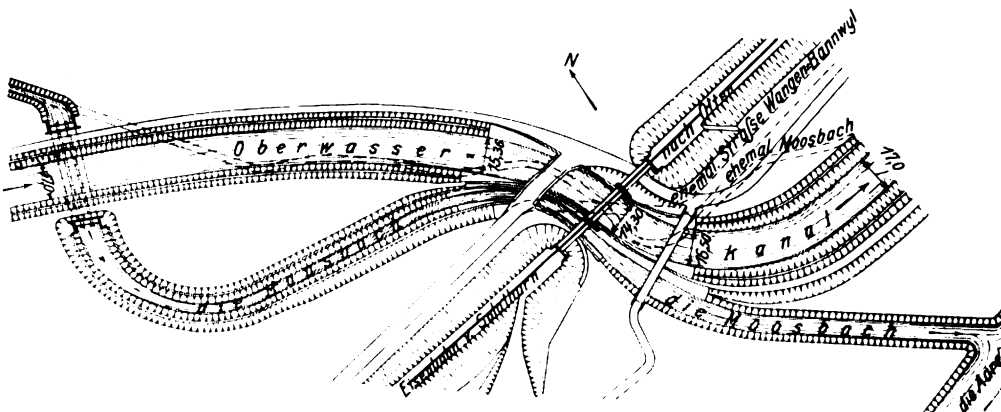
Lageplan des Kanales an der Eisenbahnbrücke.
